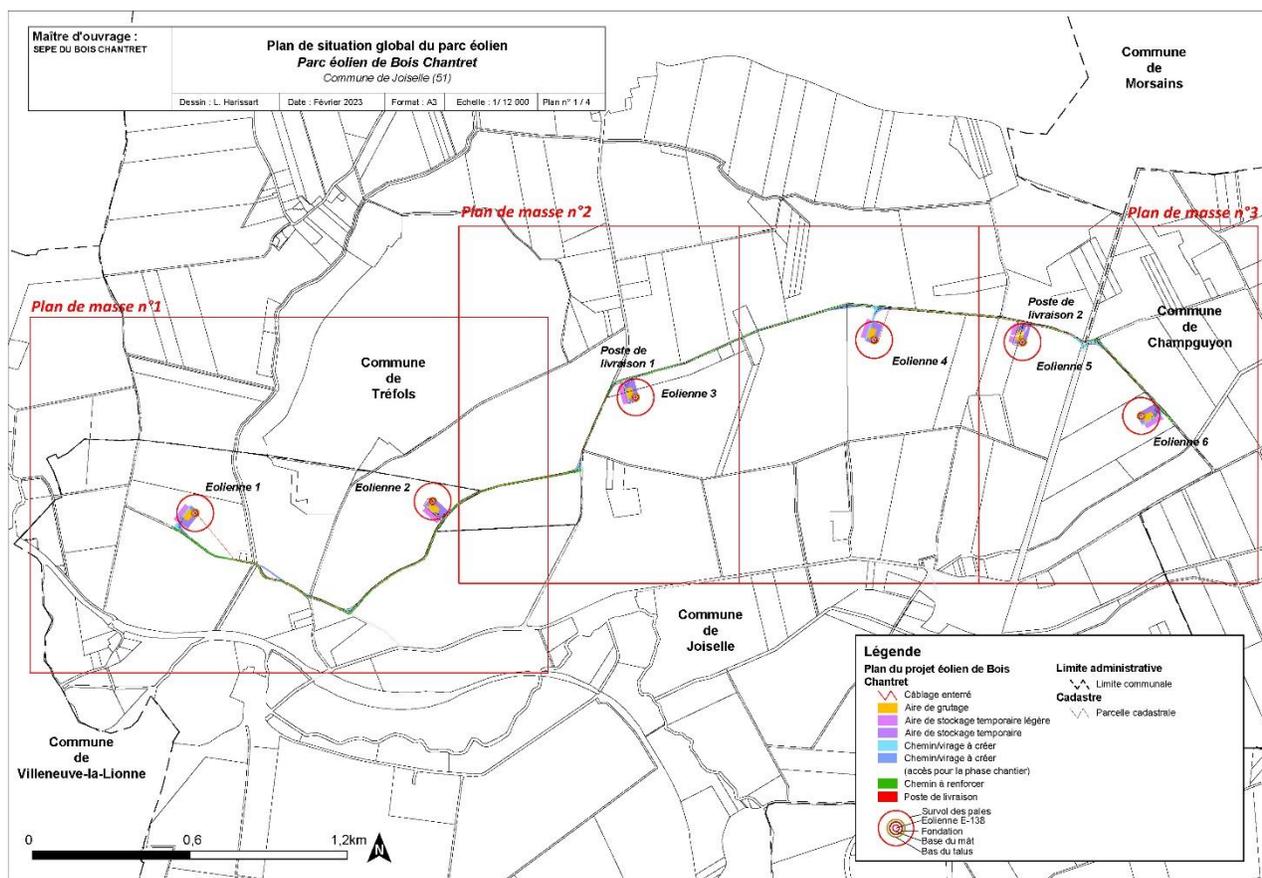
Plan de masse global du parc éolien du Bois Chantret
